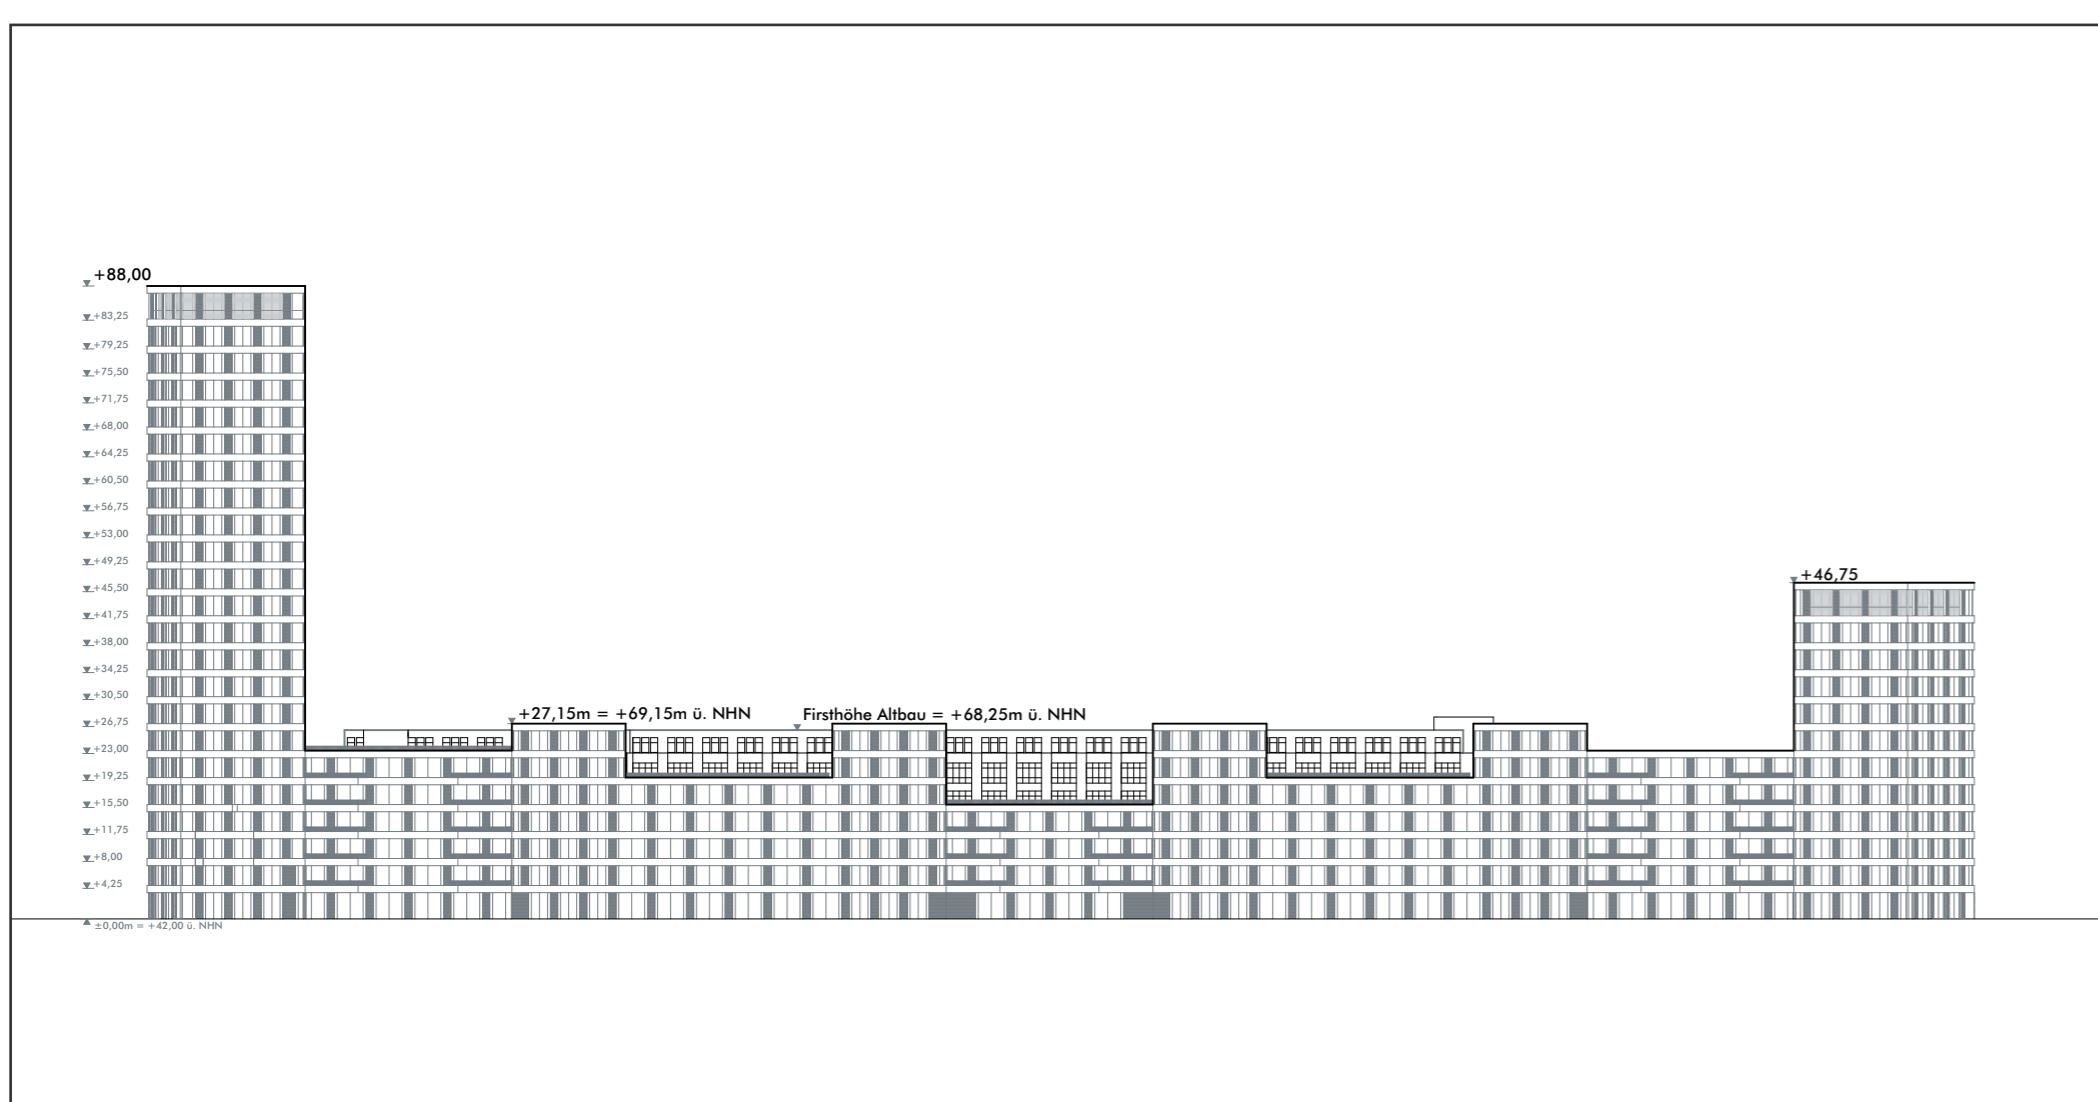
Ansicht West mit geplanten Gebäudehöhen und Fassadenstrukturen
